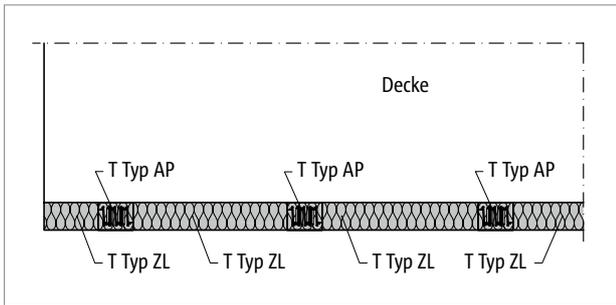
Schöck Isokorb® T Typ AP vertikale Anordnung: Grundriss Brüstung aufgesetzt
